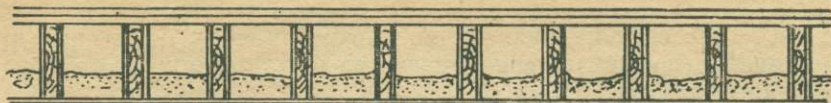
Укладка балок для деревянных междуэтажных перекрытий на выпускных плитах, см. рис. 80, или гнездах, см. рис. 68, 73 и 74.
